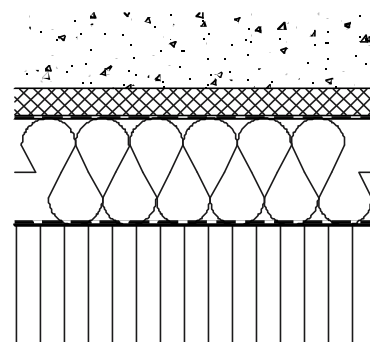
Brettstapel-Flachdach mit Begrünung
